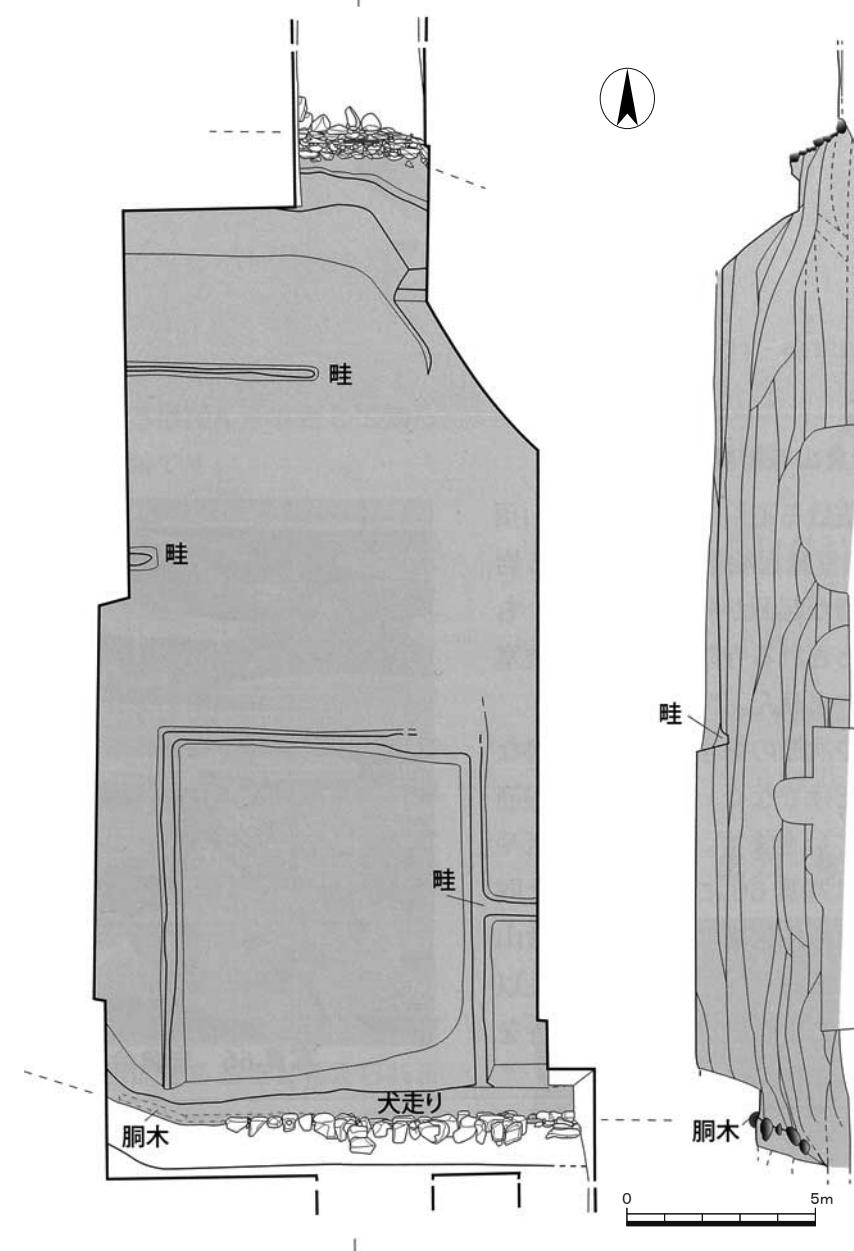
調査② 旧二条城跡南内濠跡平面・断面図(1:200)
